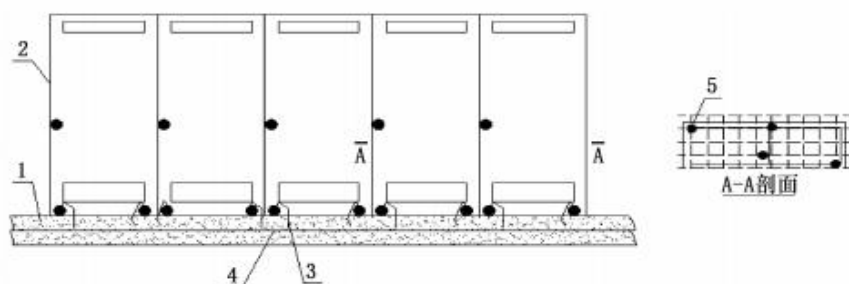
钢筋混凝土地面内焊接钢筋做等电位连接基准网示意图
